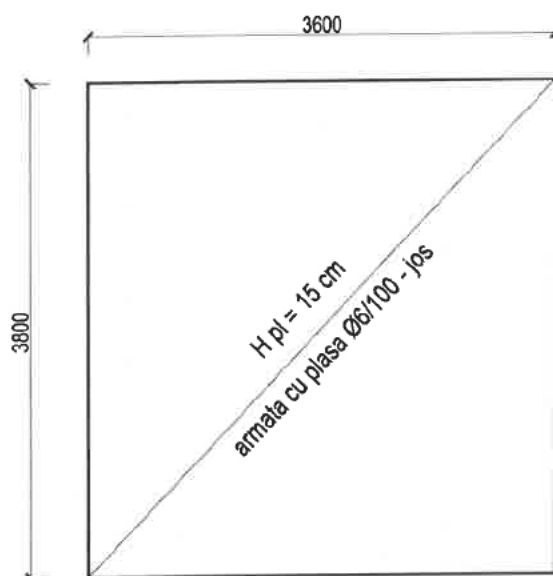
Planul de structură al platformei de beton a grupului sanitar propus
